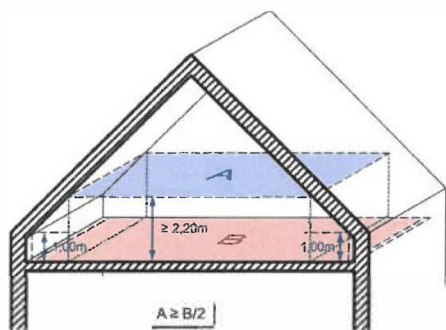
Hauteur libre sous plafond admise sous les combles (A) (B= surface de plancher hors murs prise en considération pour le calcul de A)
